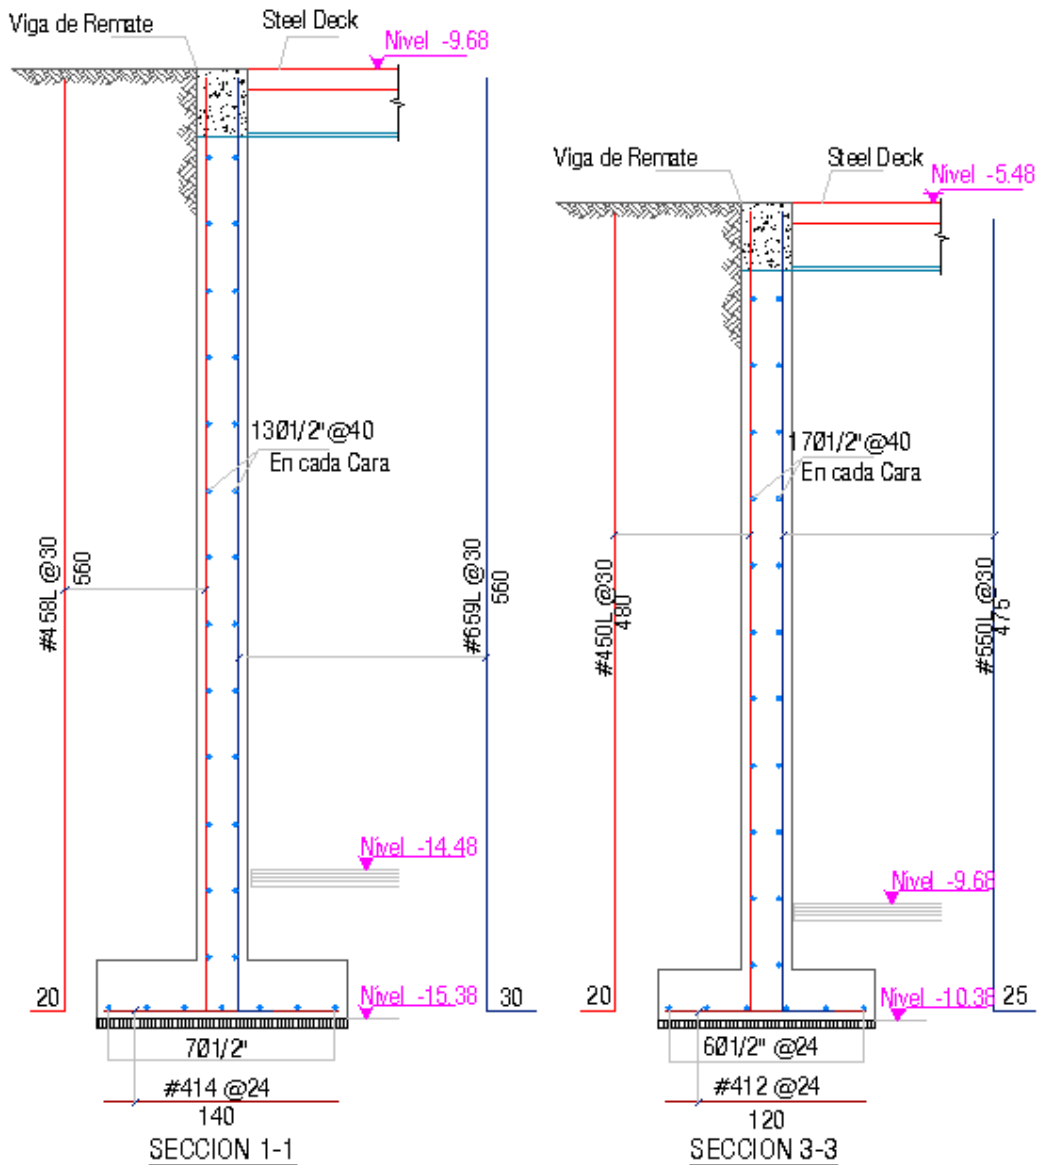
Secciones de muros de contención en sótanos 1 y 2. Fuente Estrumetal
